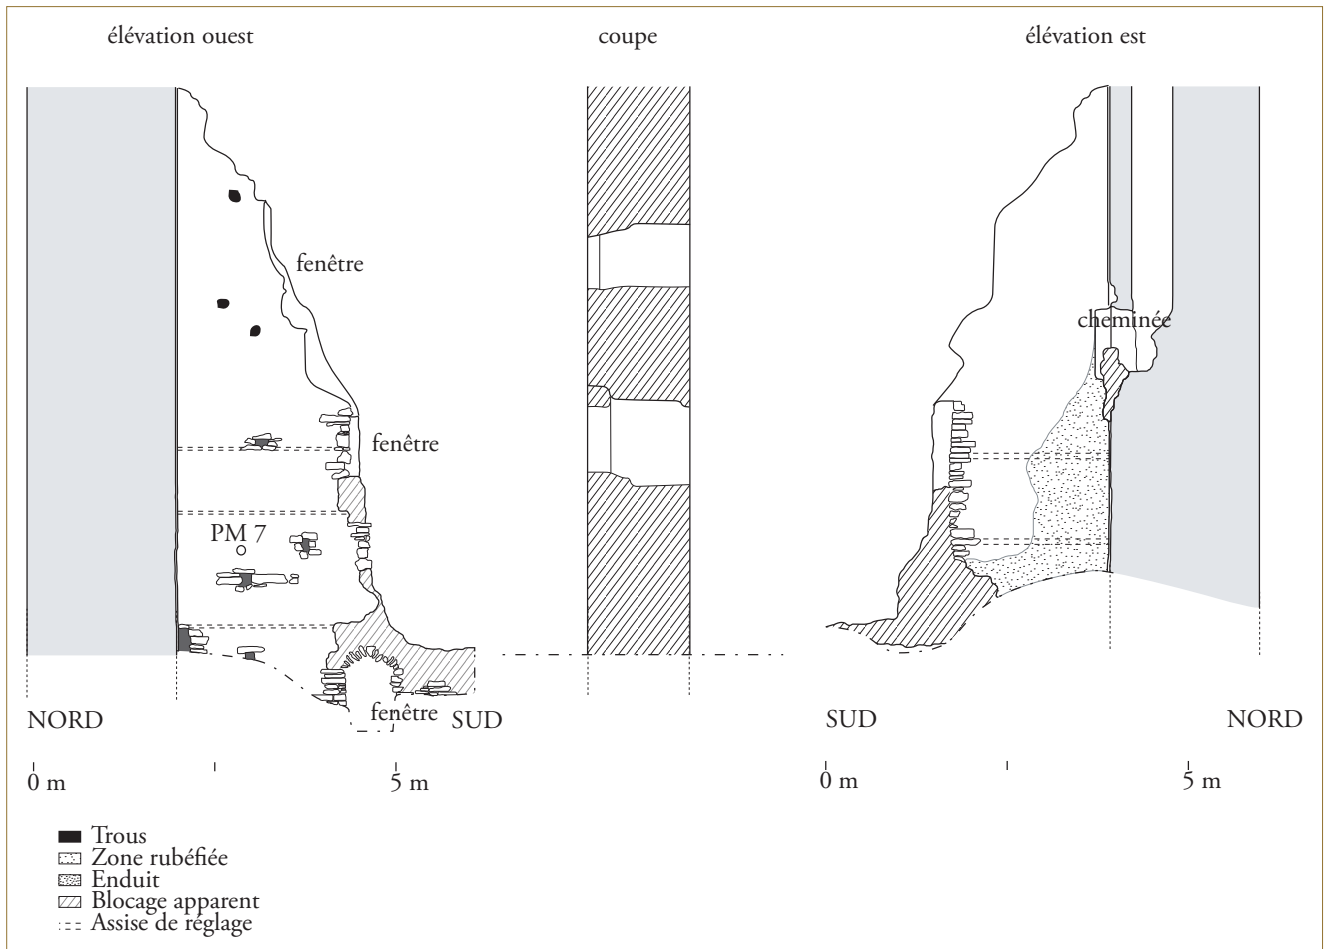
Mur de refend appuyé sur le mur nord (relevé et DAO A. Desforges).
